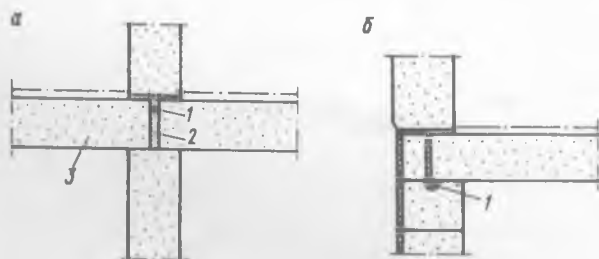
Плиты перекрытия, опирающиеся на несущую внутреннюю (а) и несущую наружную (б) стены
